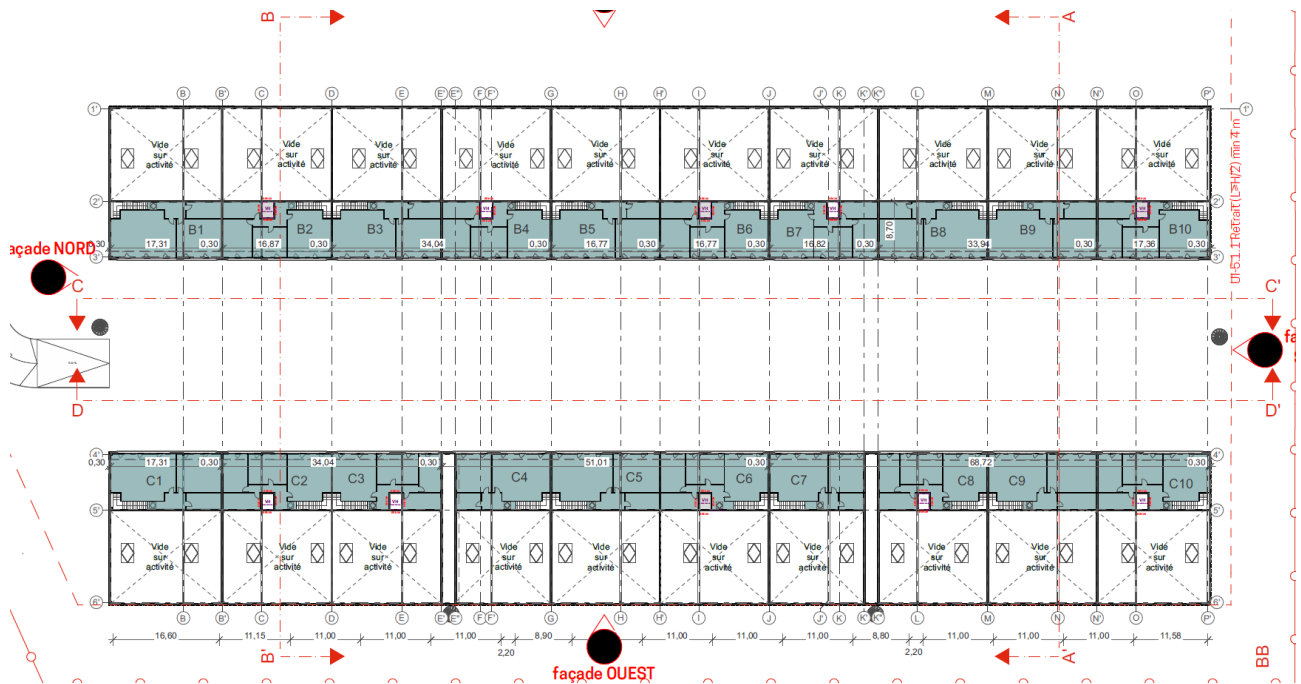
Vue en plan du R+3 (Mezzanine du R+2)[6]
